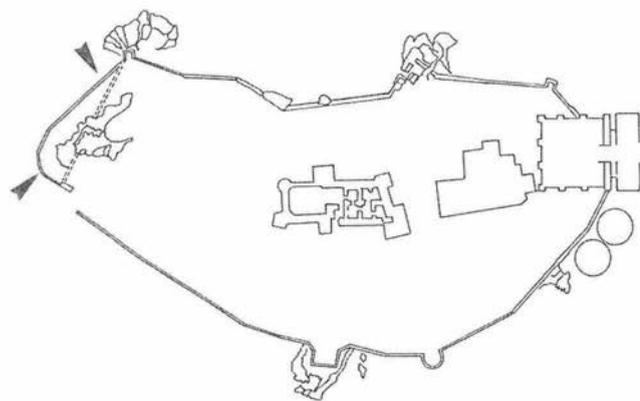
Detalles tomados del plano de la restauración de 1987.
